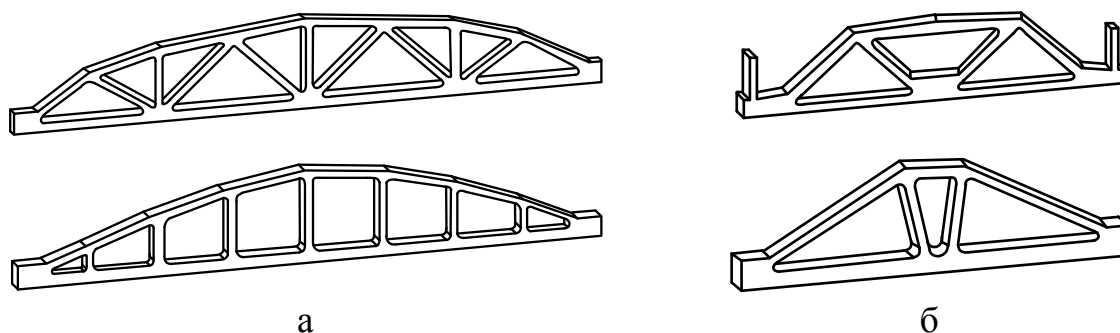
Вид фермы: а – стропильная, б – подстропильная
